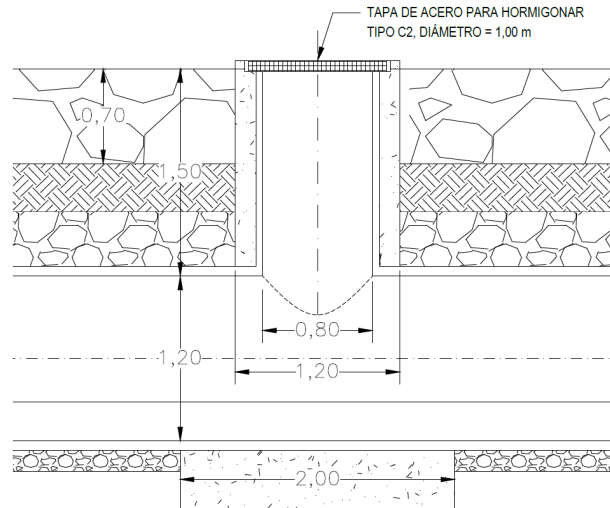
Sección Transversal Cámara de acceso dispuesta en la tubería
